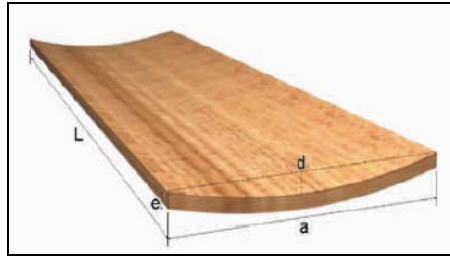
Alabeo o deformación de la madera llamado acanaladura.
